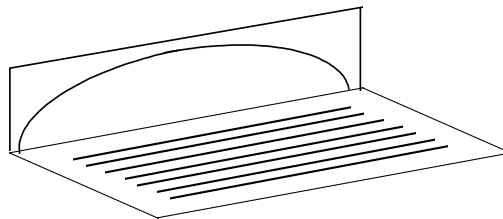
Avaloir mixte à entrée latérale et grille de caniveau
